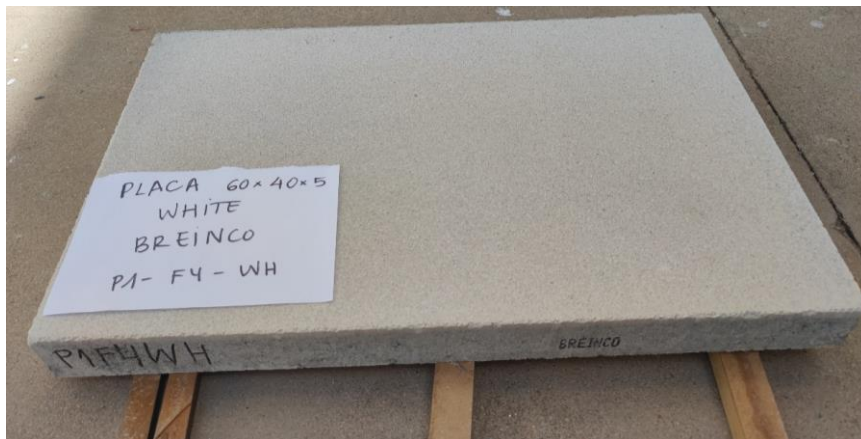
Fotografía pavimento White Breinco. Fuente: Elaboración propia
